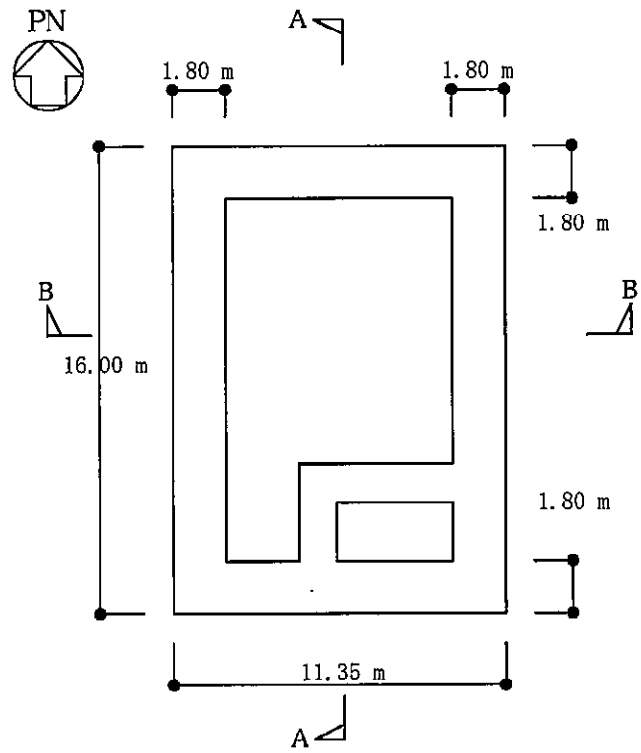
格納容器圧力逃がし装置格納槽の概略平面図 (EL. -12.8 m)
